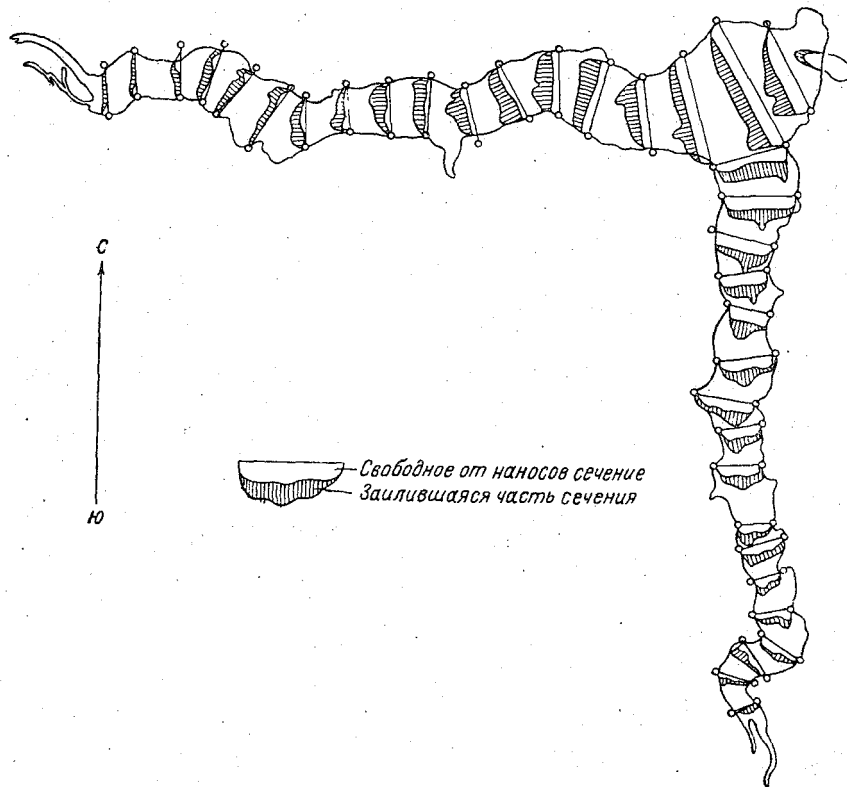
План водохранилища Кварто с нанесенными поперечниками до и после заиления.
